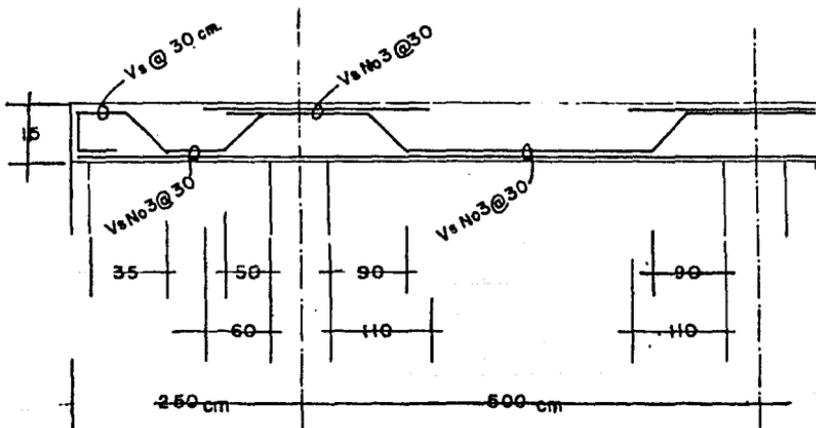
ARMADO TIPO DE LA TECHUMBRE.
